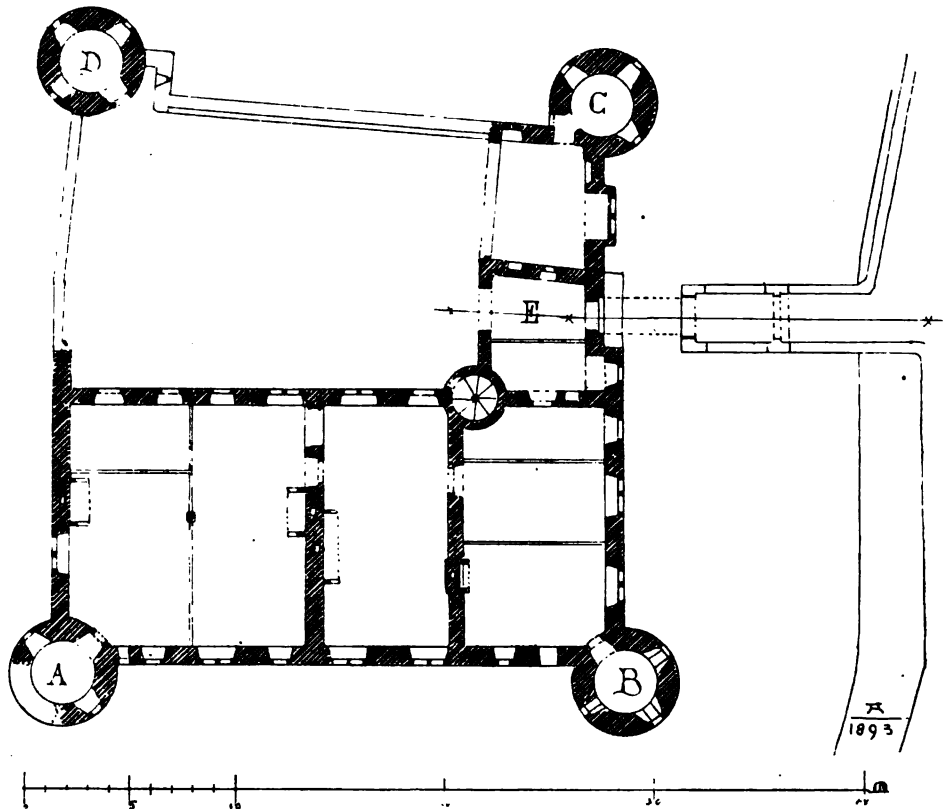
Burg Konradsheim. Grundriss.
